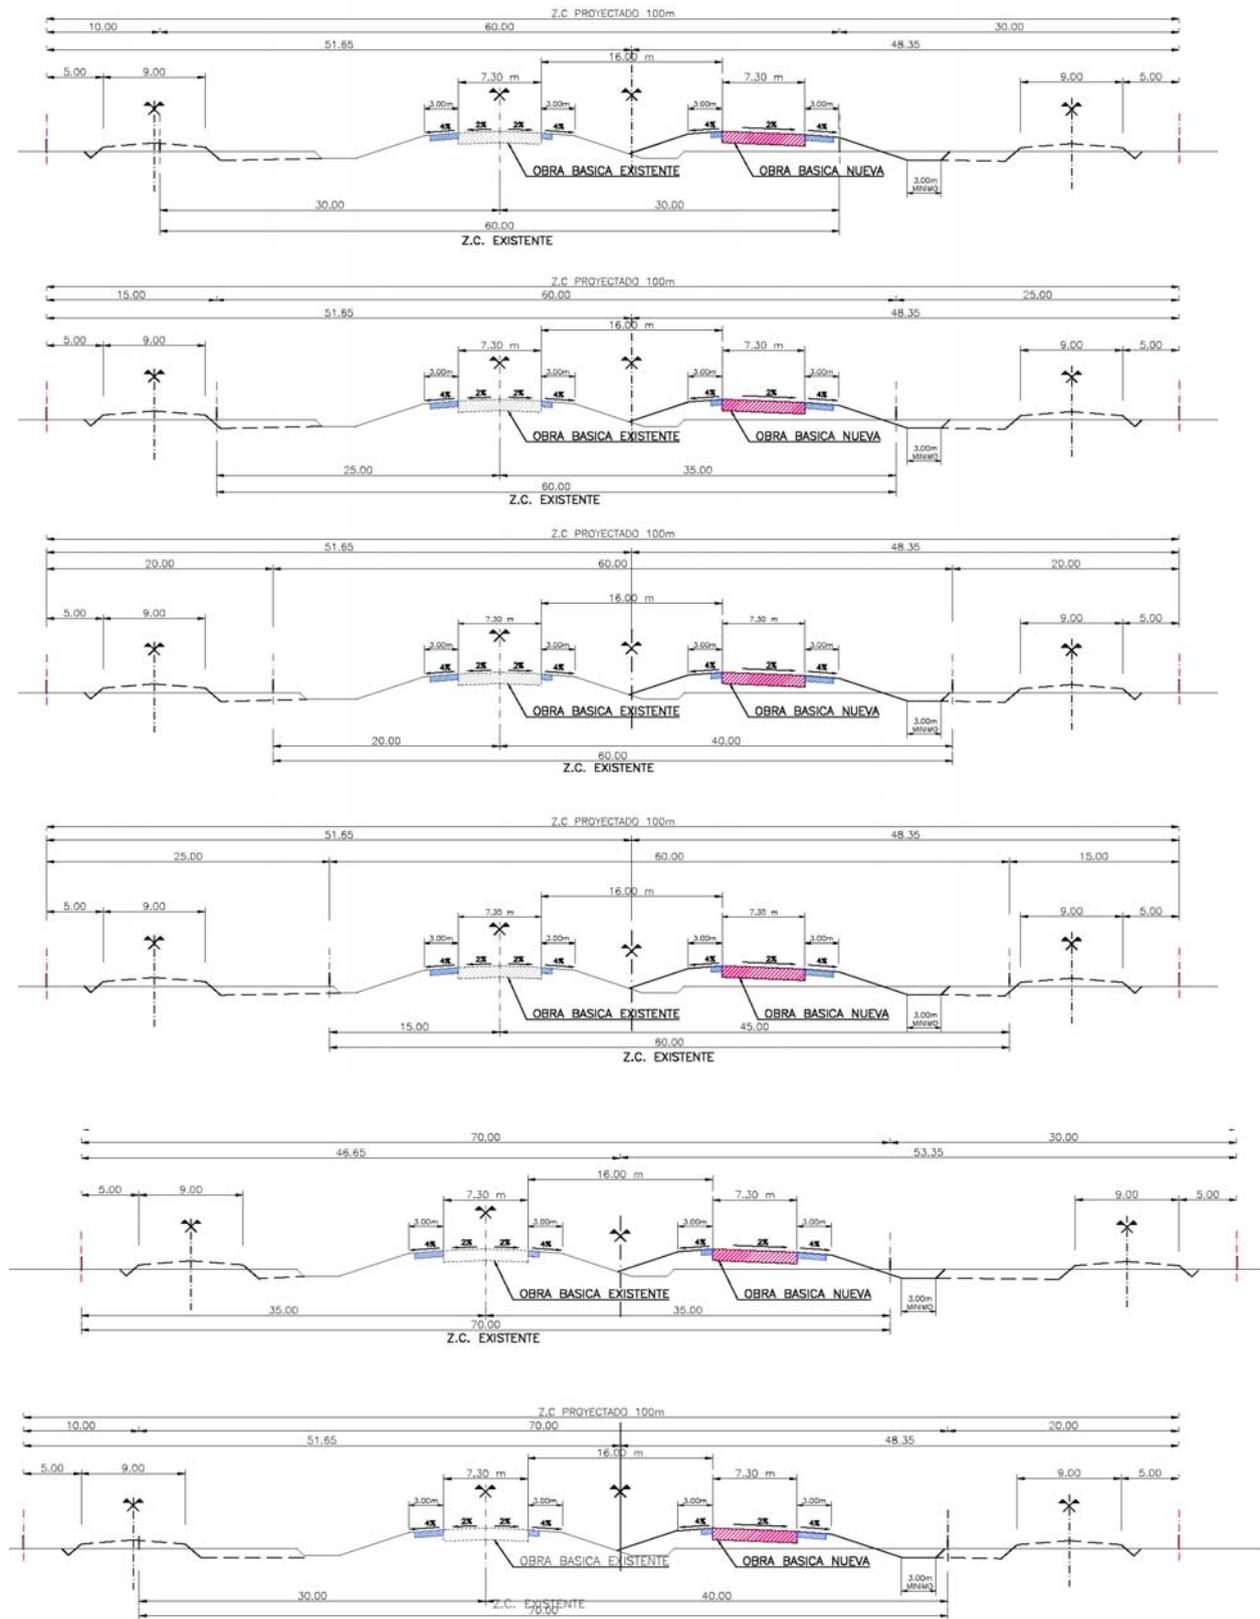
Perfiles de duplicación de calzada con ZC actual de 60 y 70 m.
